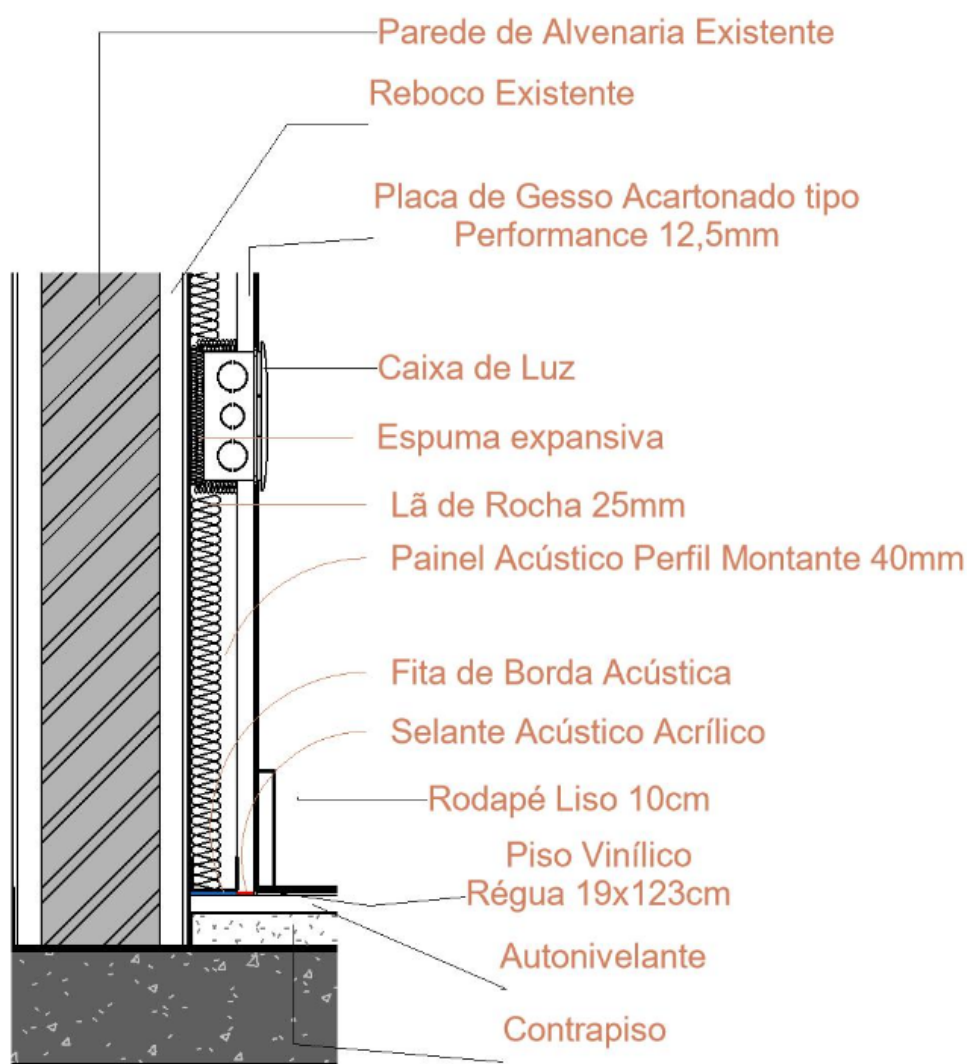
elementos do sistema de painel drywall para melhoramento acústico
